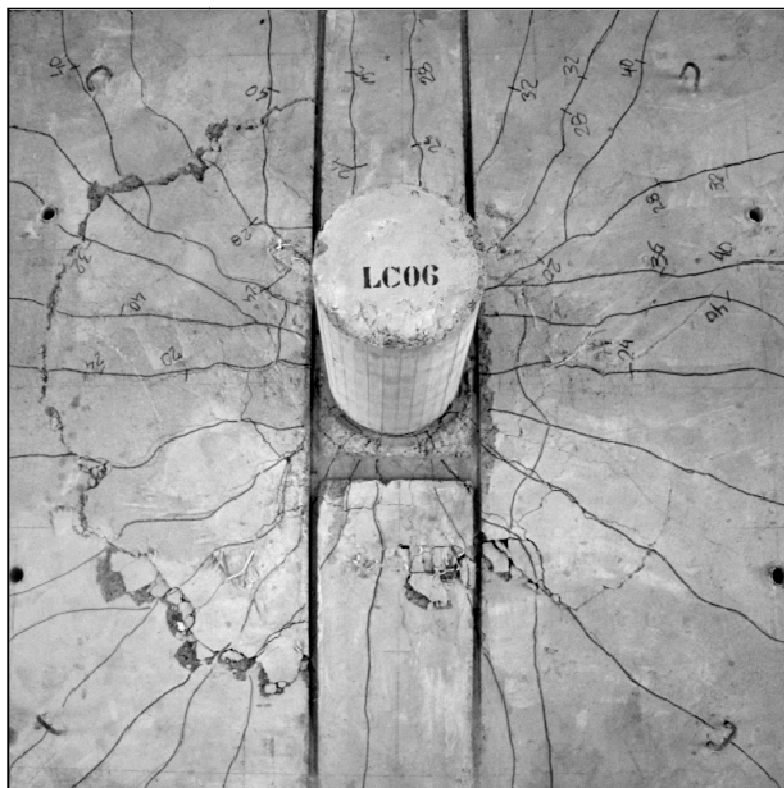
Mapa de fissuração da laje LC06
